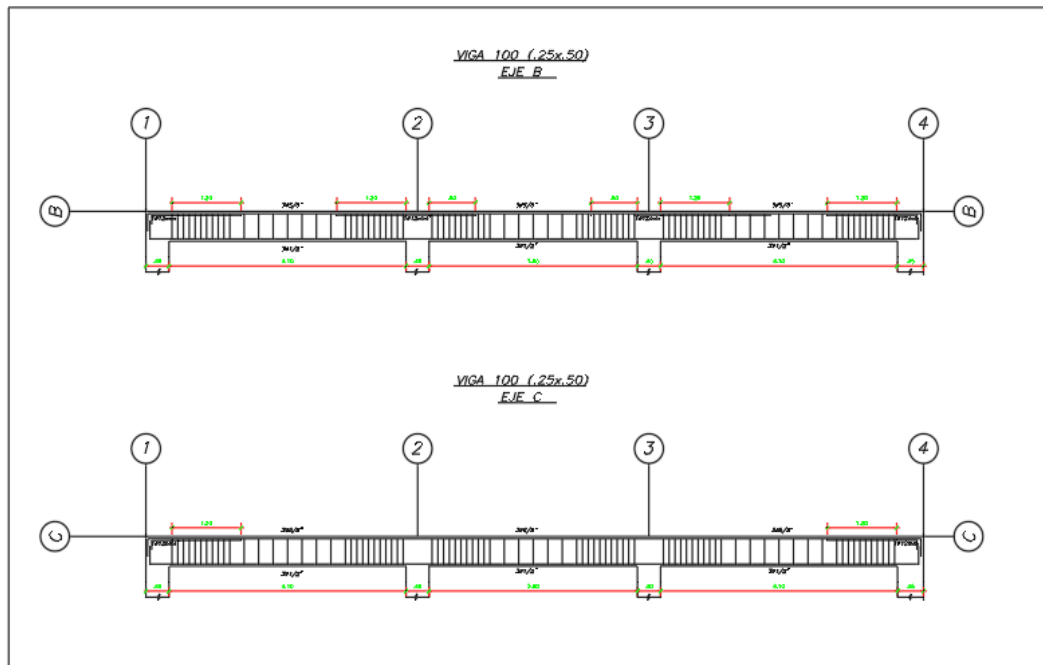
Acero longitudinal en vigas del eje B y C del primer nivel.
